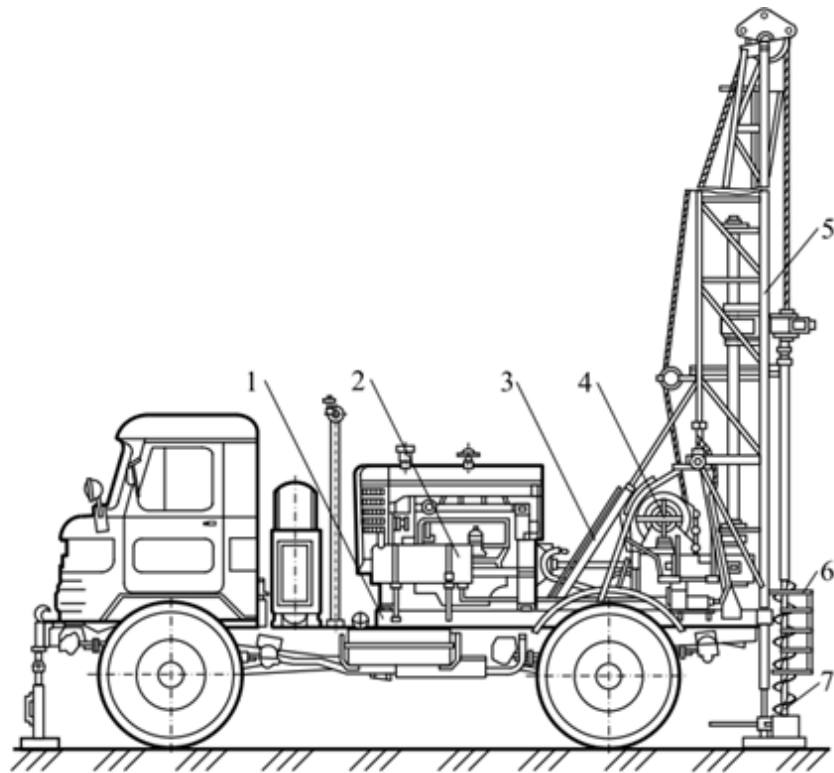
Бурова установка УГБ 50-М [10]: 1 – рама; 2 – двигун; 3 – гідроциліндри; 4 – лебідка; 5 – щогла; 6 – огороження; 7 – шнек
